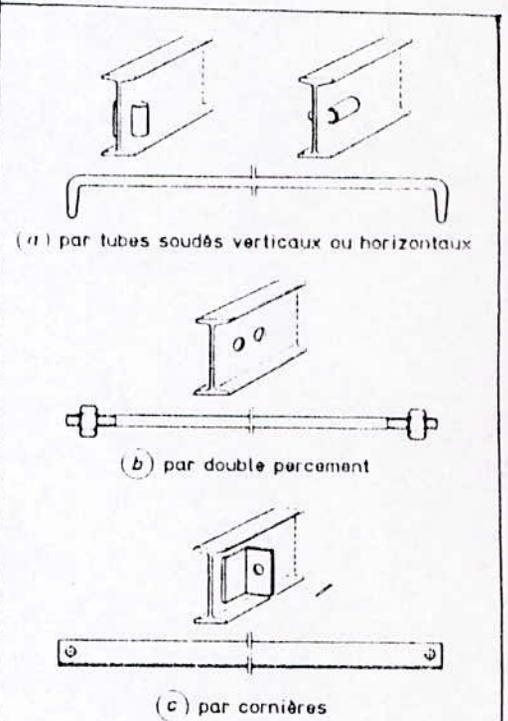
Dispositifs d'entretoisement de cintres lourds
